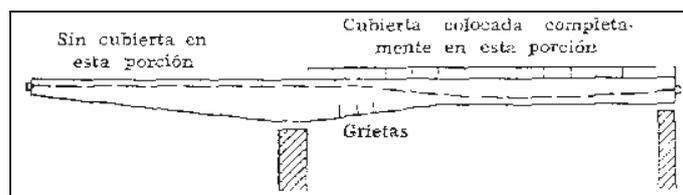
Agrietamiento de una viga debido a la secuencia errónea de aumentar la carga superpuesta [2].
